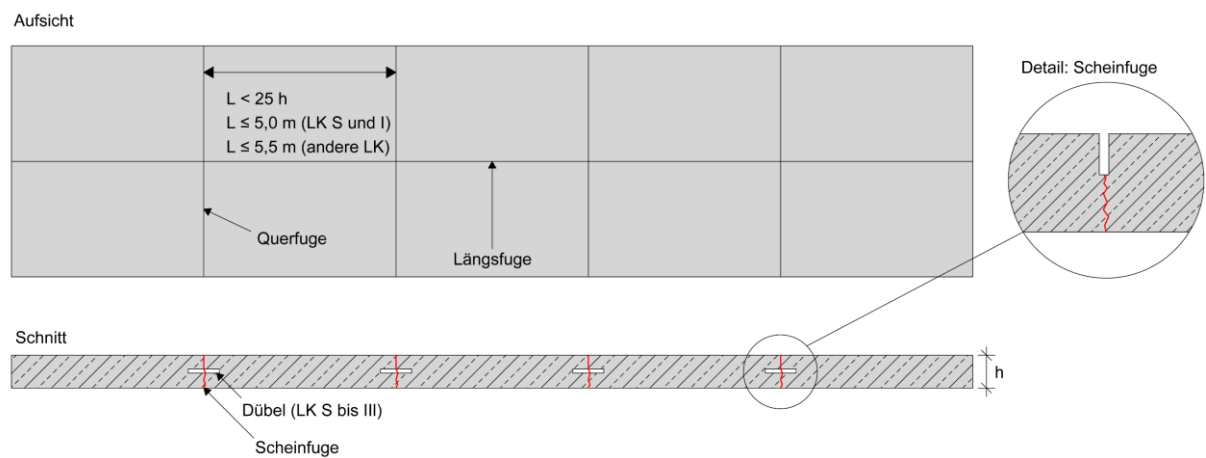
Unbewehrte Betondecke mit Längs- und Querfugen (schematische Darstellung) [2]
